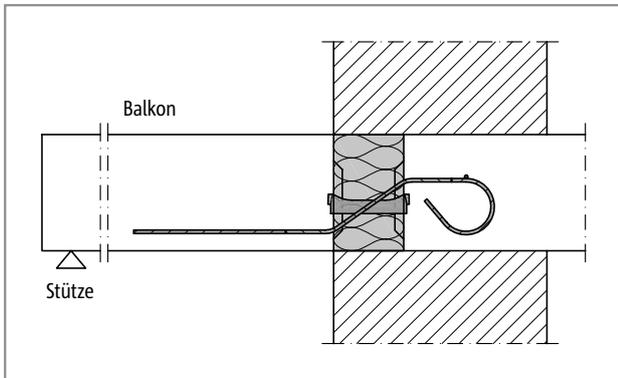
Schöck Isokorb® Typ QXT: Anschluss bei einschaligem, wärmedämmendem Mauerwerk (Typ QXT10 bis QXT40)
